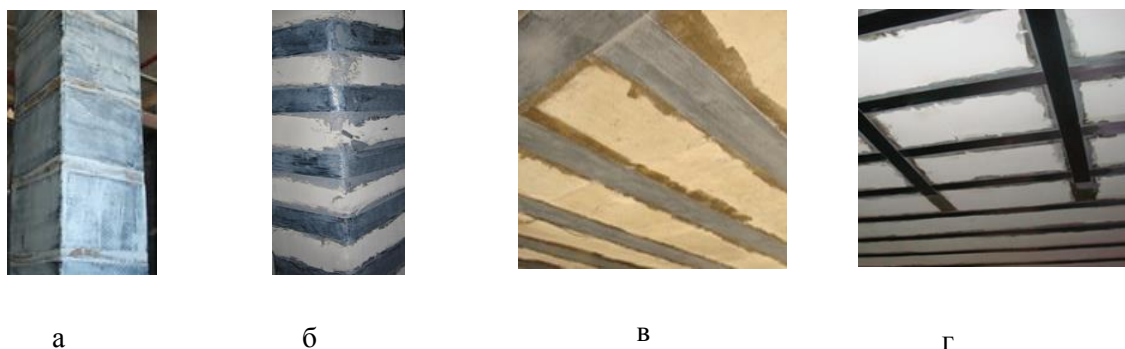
Усиление железобетонных колонн (а, б) и плиты (в, г) тканями из угле – и стекловолокна и углепластиковыми ламелями (а, в – ткани; б, г – ламели)
